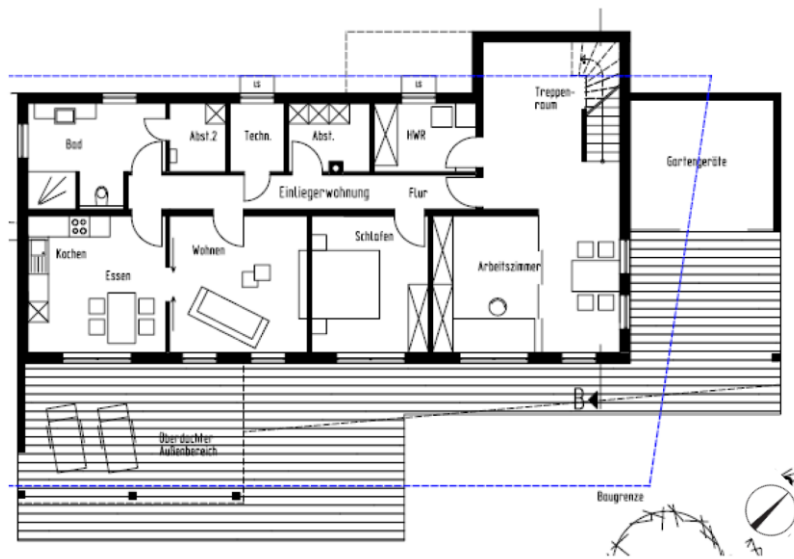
Grundriss Untergeschoss (Quelle: Architekturbüro N. Hoffmann)
